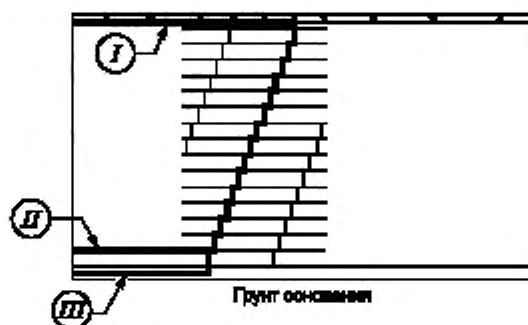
Типовое поперечное сечение насыпи с вертикальными откосами с учетом трех видов разрушения
